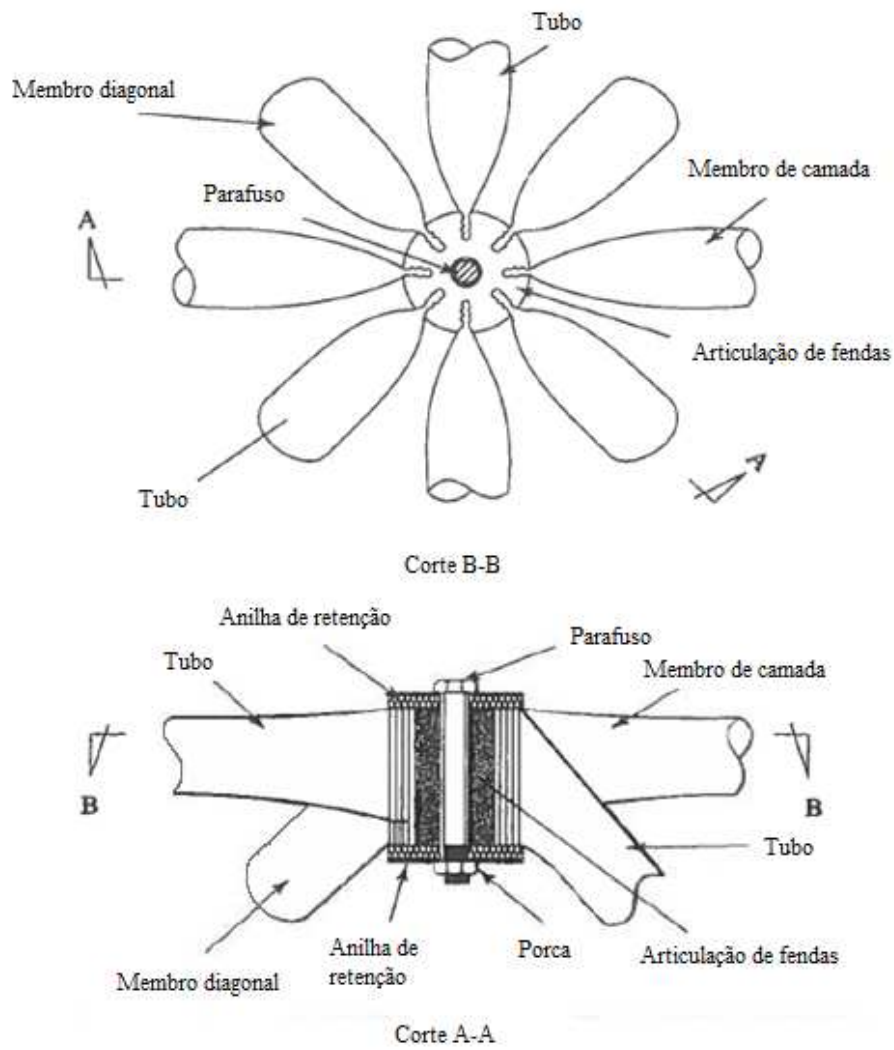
Pormenores de conexão do sistema Triodetic (adaptado de [78]).
